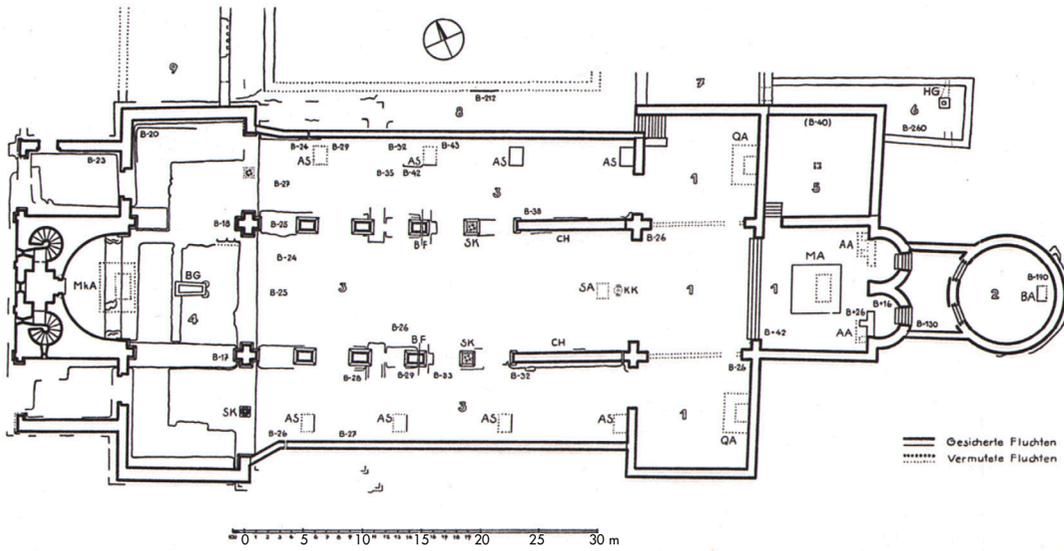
Reichenau-Mittelzell, St. Maria und Markus. Grundriss Mitte 11. Jahrhundert mit dem unter Abt Berno (1008–1048) errichteten Westquerhaus.
